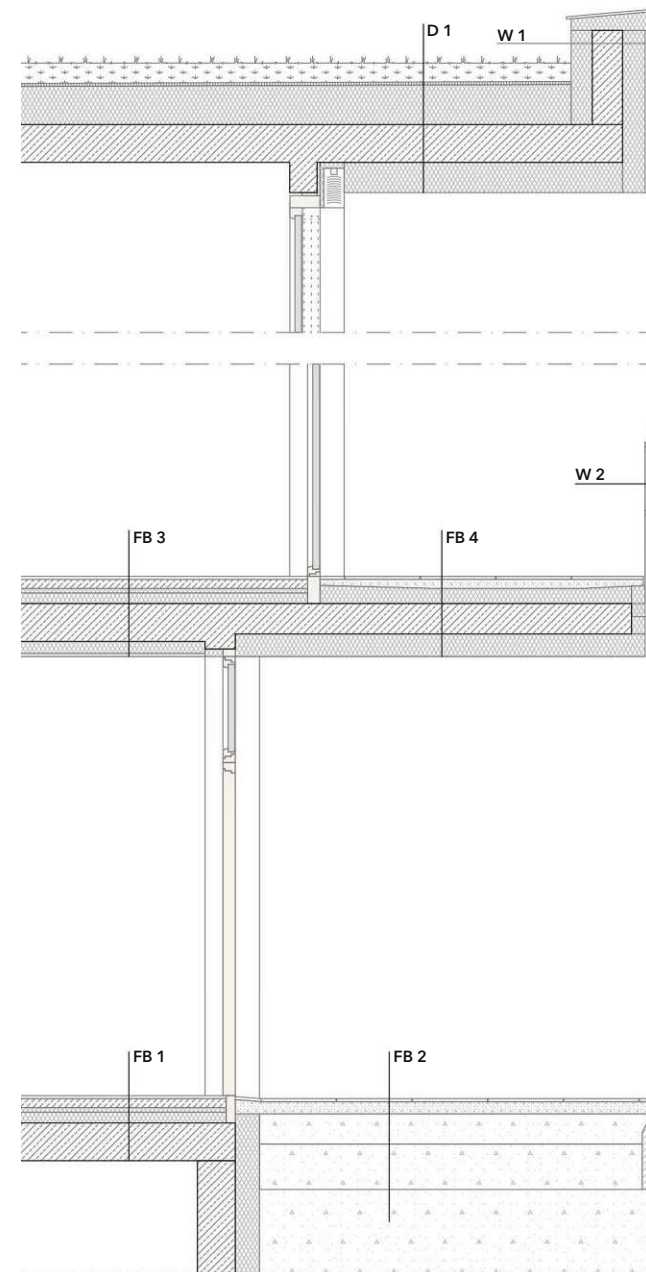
Fassadenschnitt 1:50 Hauptgebäude Wohnungen
